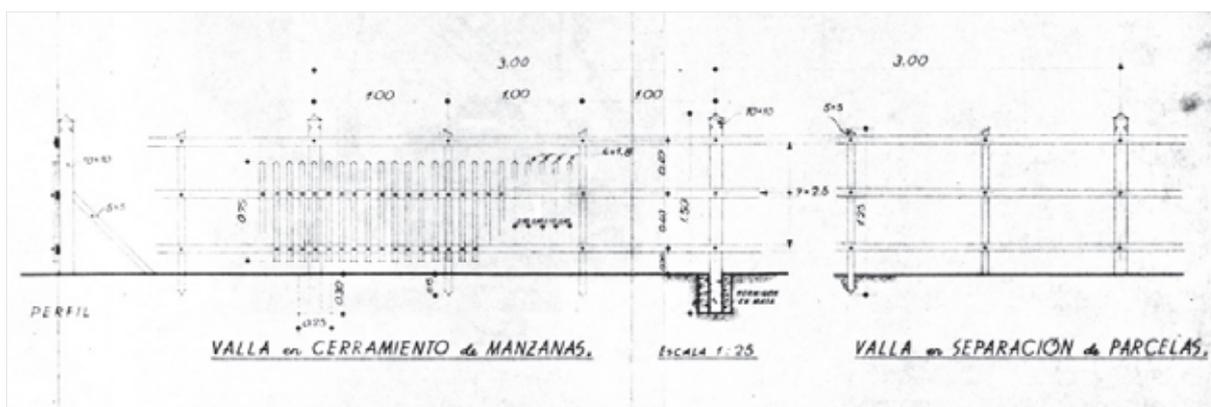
Plano con los detalles de las vallas de madera del «Proyecto de Barriada Yagüe de 302 viviendas protegidas ultrabaratadas para la Obra Sindical del Hogar en Soria». Arquitecto Juan Sendín, junio de 1947.
